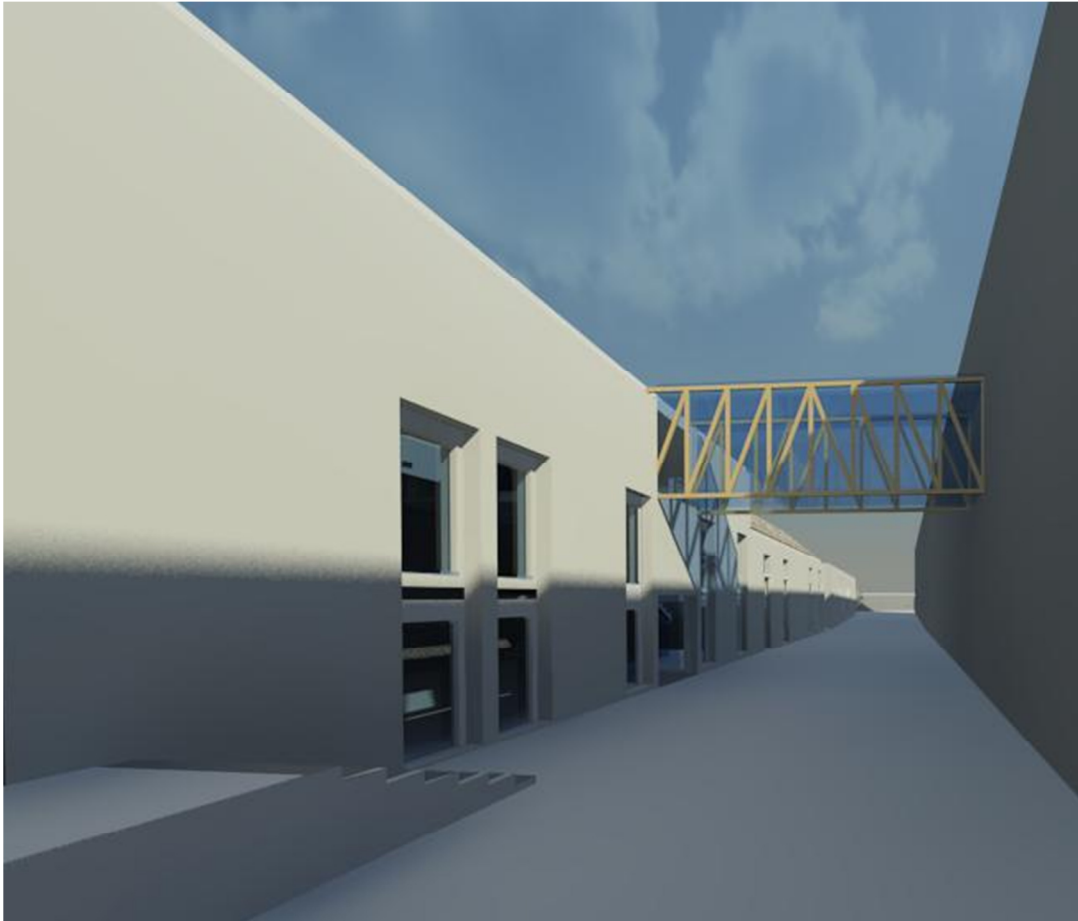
Vista da entrada do edifício proposto e da ponte de ligação ao Mosteiro
